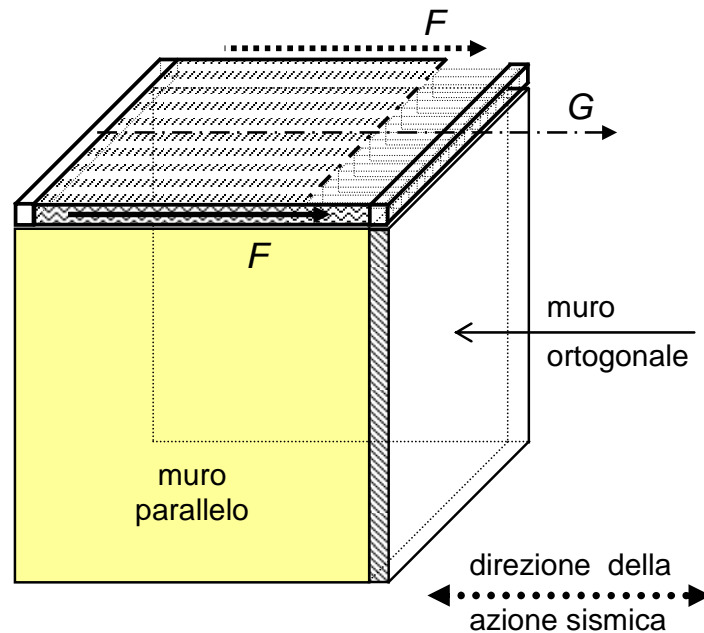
f/1°. La struttura è investita da un'azione sismica avente la medesima direzione dei casi *b*, *c*, *d* (doppia freccia in linea forte, punteggiata). La vibrazione sismica dell'impalcato è staticamente equivalente alla forza di piano *G* (vettore con linea tratto-punto). L'impalcato è assimilabile a infinitamente rigido nel proprio piano, grazie alla cappa; inoltre è solidarizzato a tutti e quattro i muri al contorno, grazie al cordolo e alle cuciture di quest'ultimo. Conseguentemente, l'impalcato scarica la forza sismica di piano *G* sui muri
